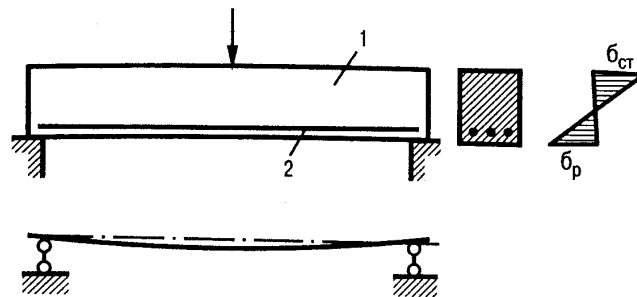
Схема роботи арматури в залізобетонній конструкції:
